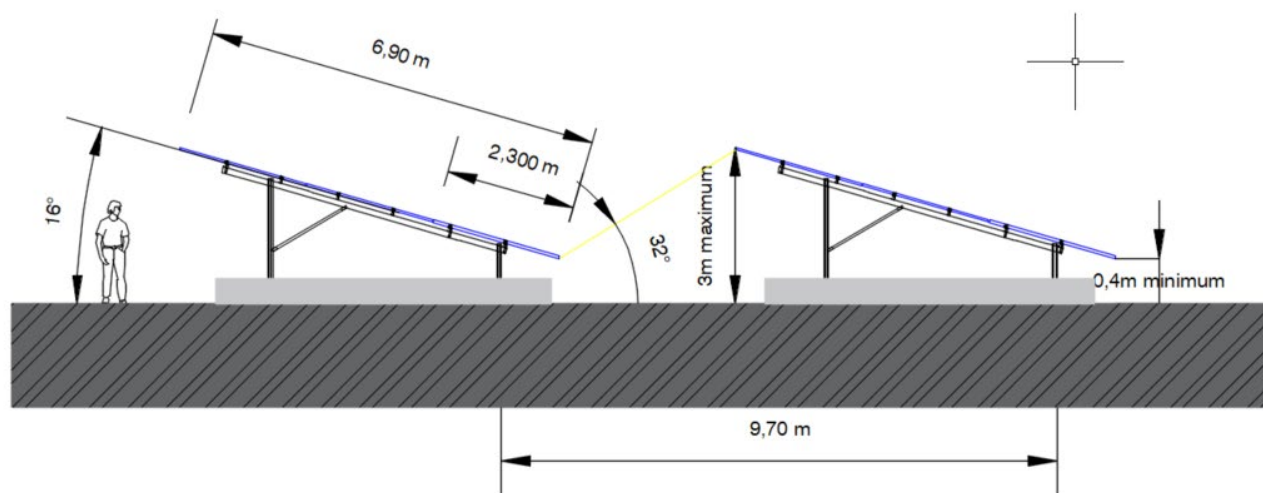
Vue en coupe des panneaux photovoltaïques au sol prévues dans le cadre du projet
